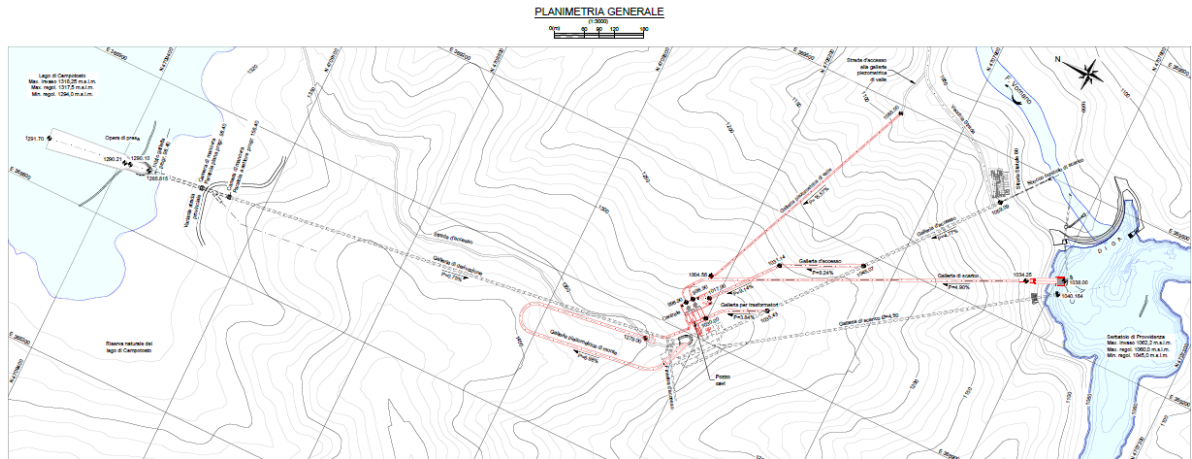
Impianto di Provvidenza – Schema planimetrico delle opere esistenti e in progetto
